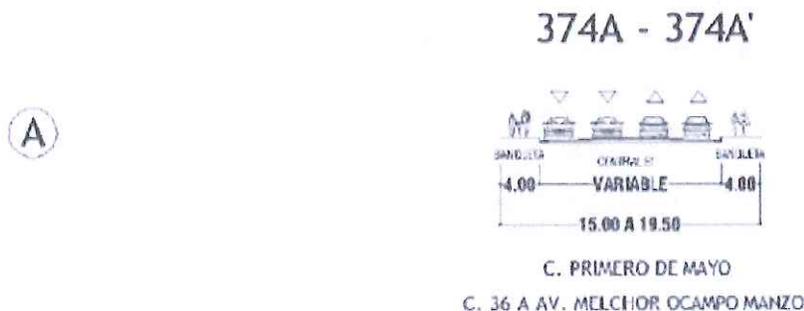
Sección vial actual para calle Primero de Mayo. Fuente PDU 2040.
